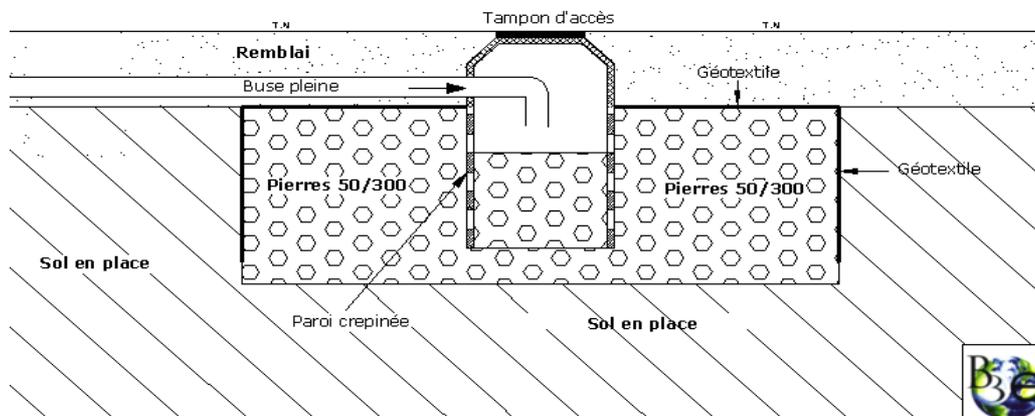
Coupe schématique d'un puits d'infiltration (source : B3E)
